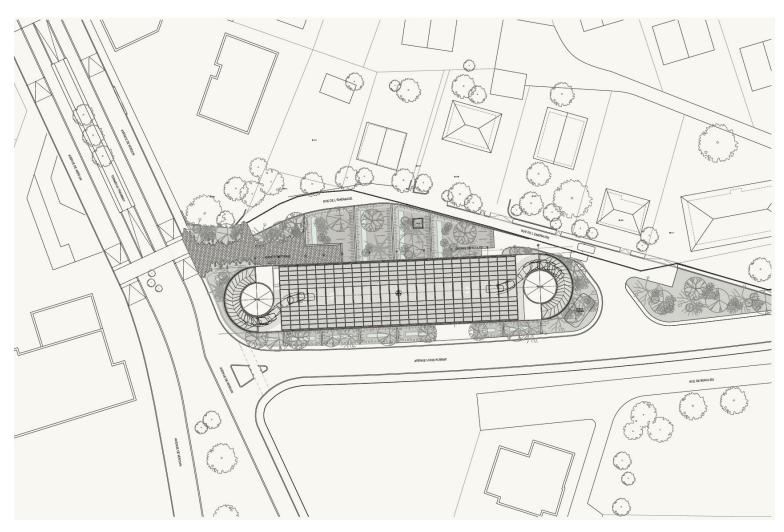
Plan du projet du P+R Aubrac (APS Clément Vergély Architectes, 2023).
